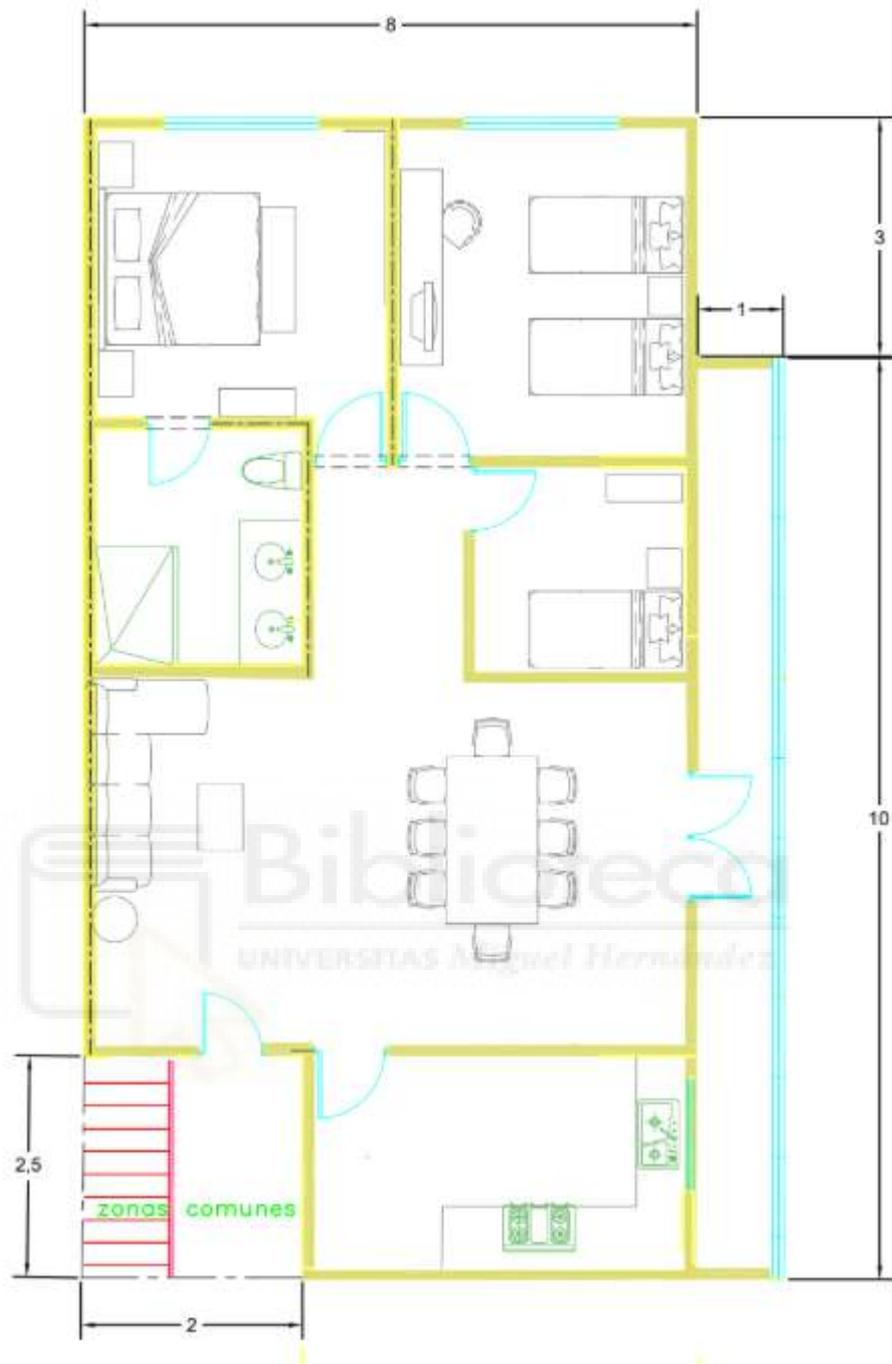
Plano de la vivienda 2° B con medidas realizadas in situ
